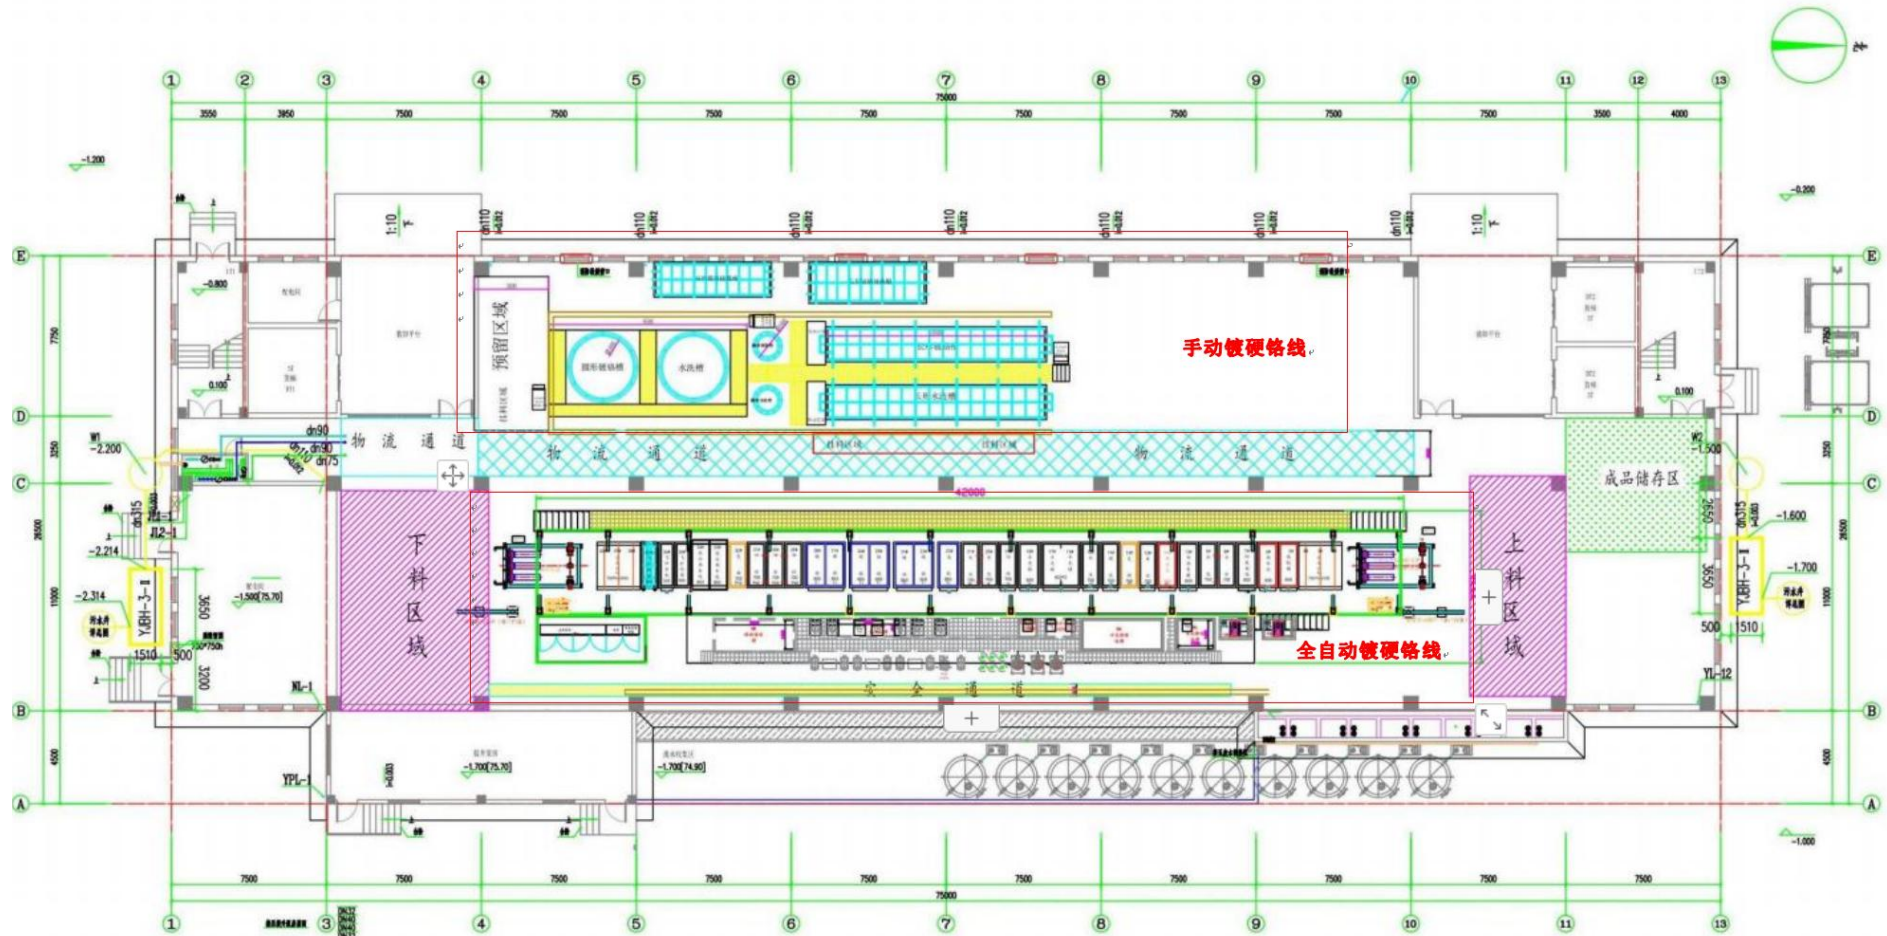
厂房 4 一楼电镀车间（全自动镀硬铬线、手动镀硬铬线）平面布置图
